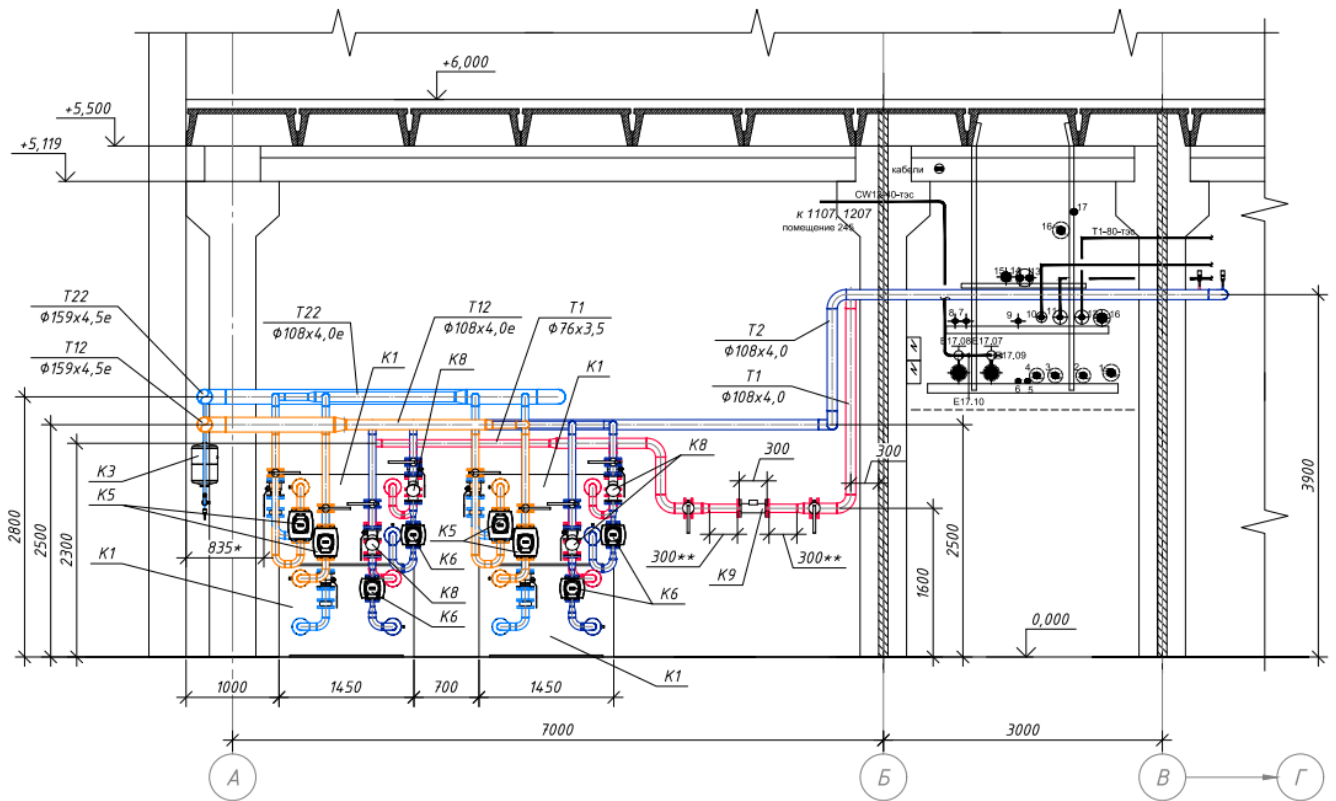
Розташування обладнання та трубопроводів. План на відм. 0.000
